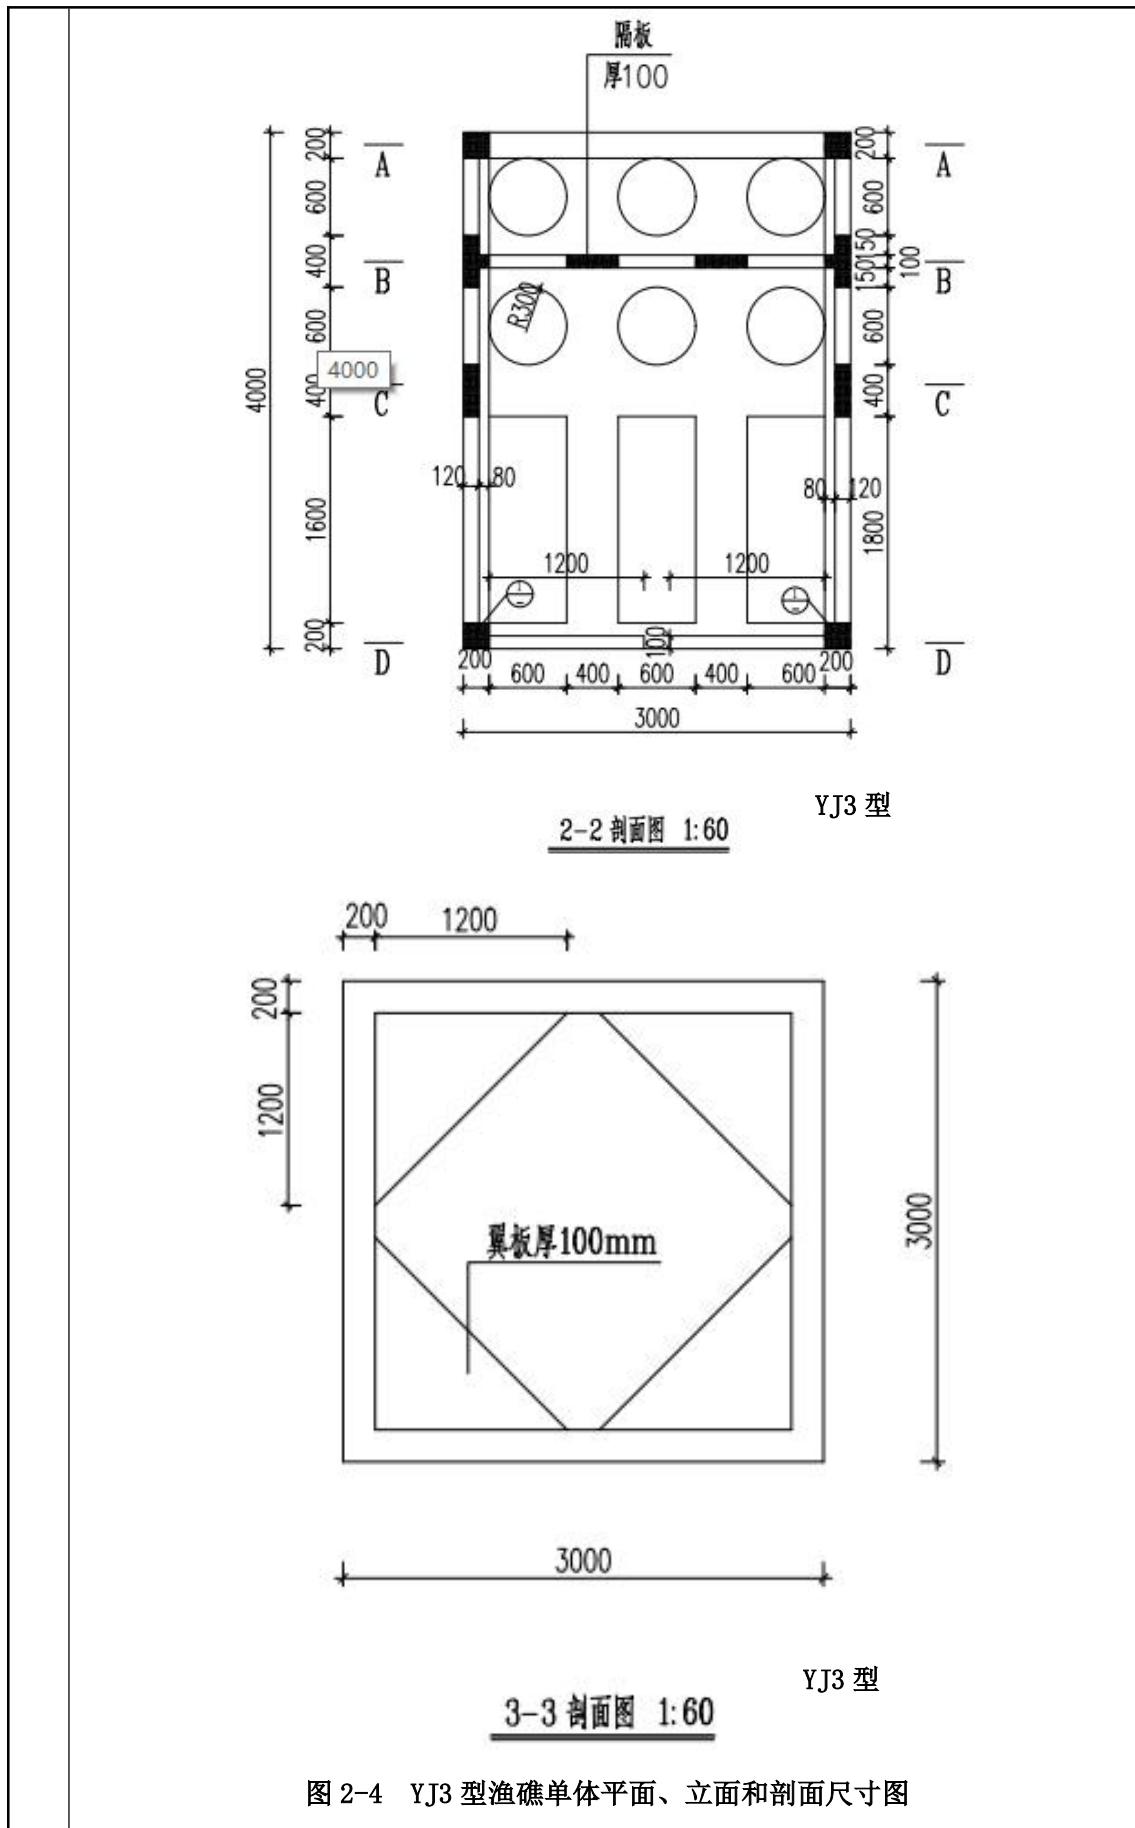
YJ3 型渔礁单体平面、立面和剖面尺寸图
